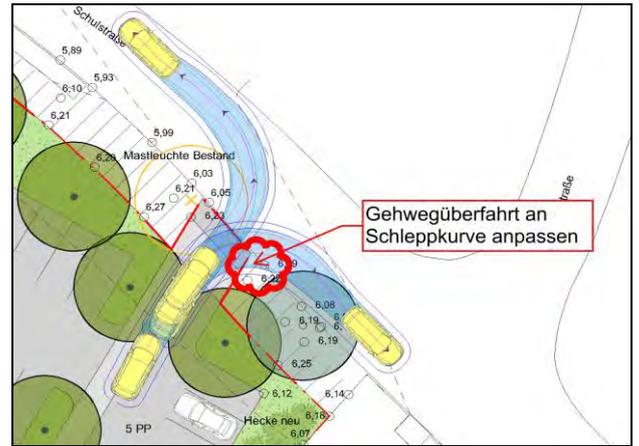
Ausfahrt – Parkierungsanlage Ost
